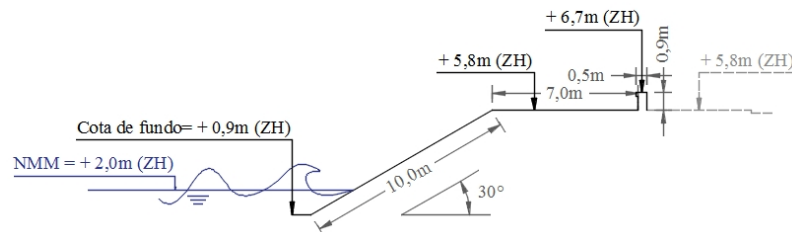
Corte transversal esquemático da obra longitudinal aderente do Furadouro (DA8).
